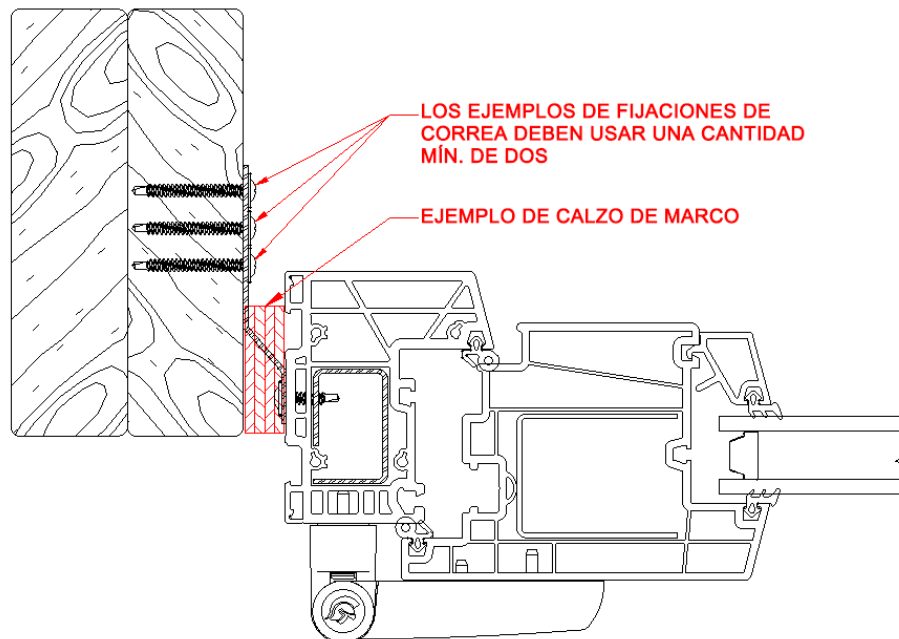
Ejemplo de puerta correctamente calzada y fijada
